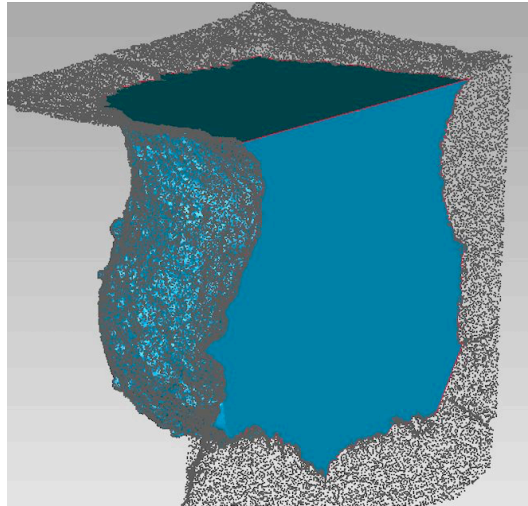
Vue 3D de la section d'essai en béton VBS-U1
